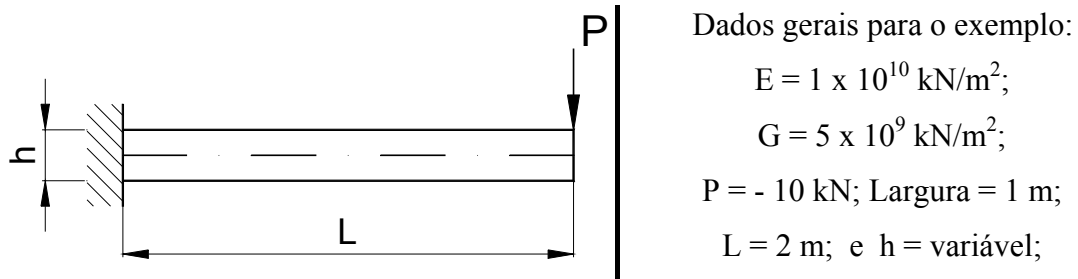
Viga em balanço com carga concentrada na extremidade livre.
